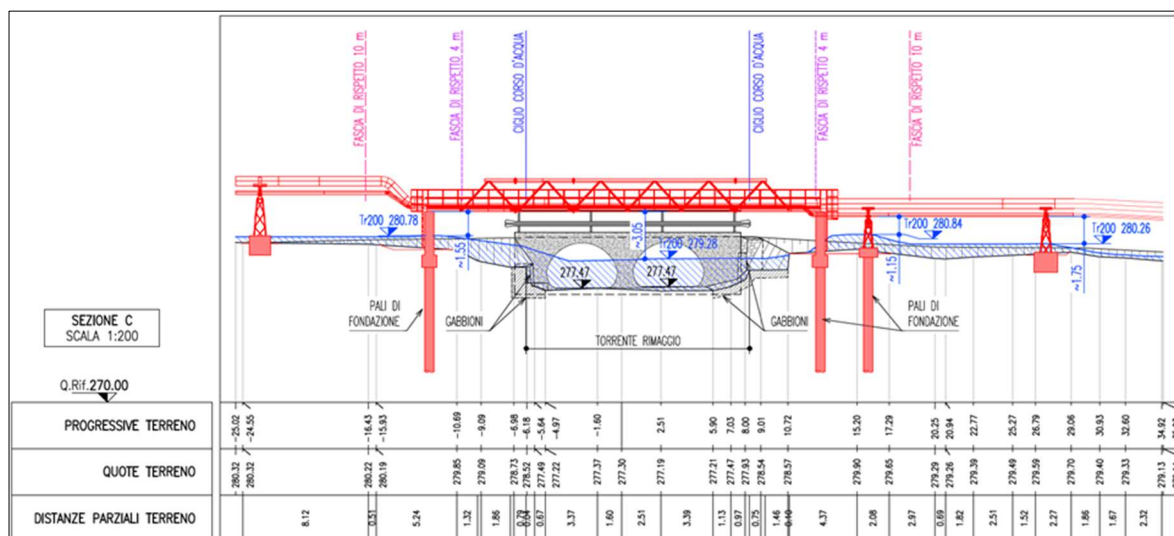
Sezione longitudinale della struttura di attraversamento sul Torrente Rimaggio
